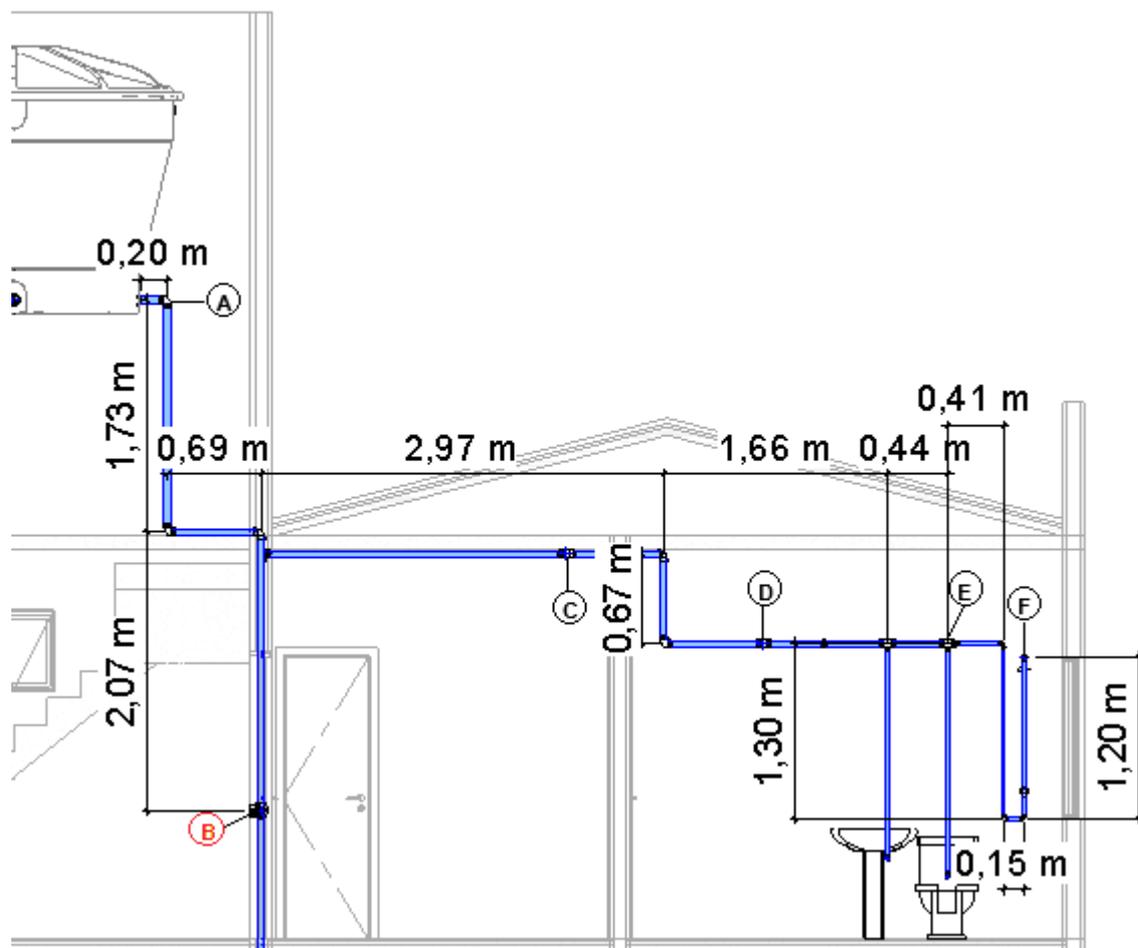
Subdivisão dos trechos para o primeiro cenário
